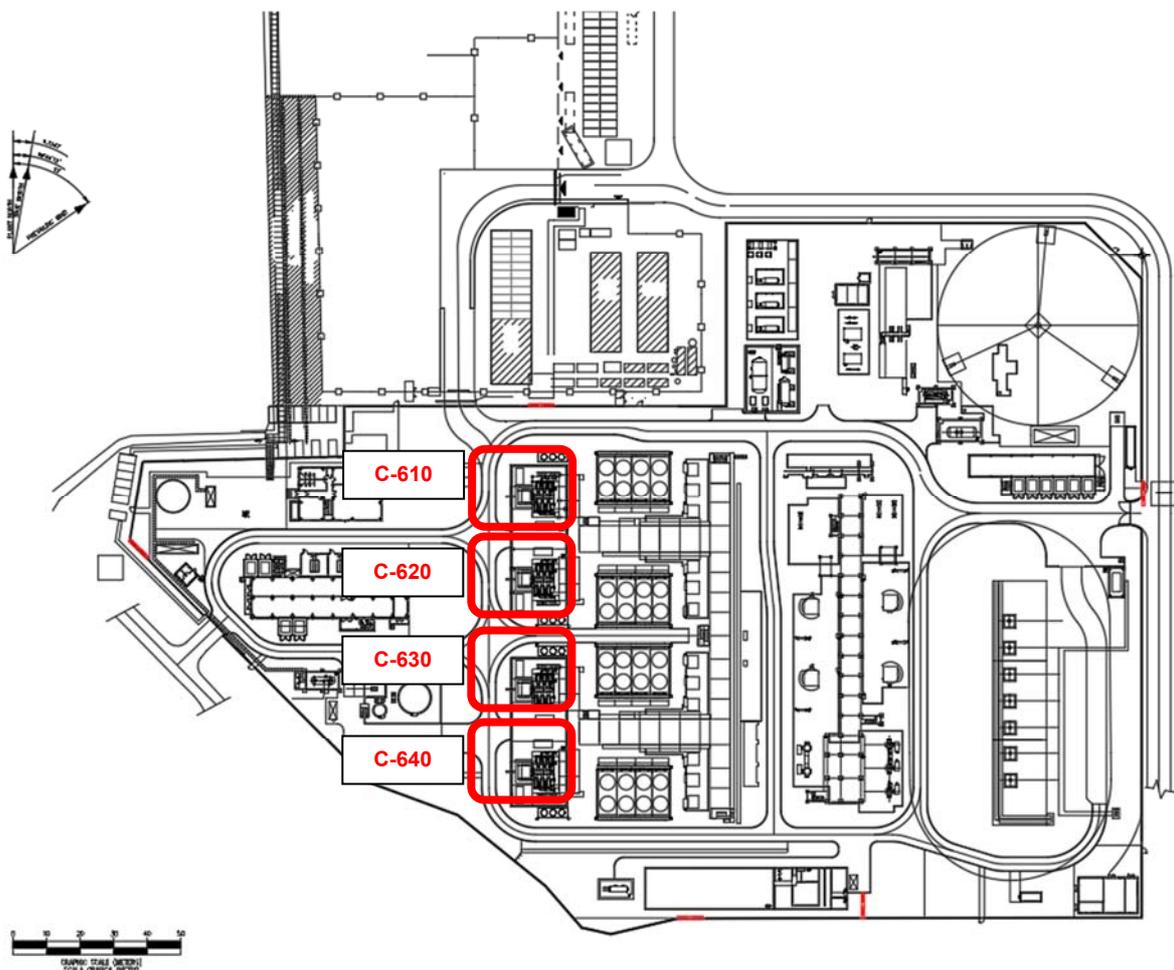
A Planimetria dell’impianto, con indicazione delle n. 4 linee di compressione
